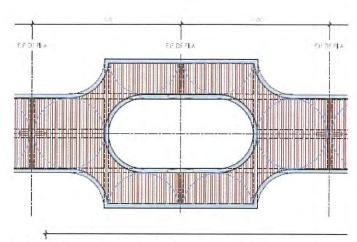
Vista en planta de la propuesta de trabes metálicas.
